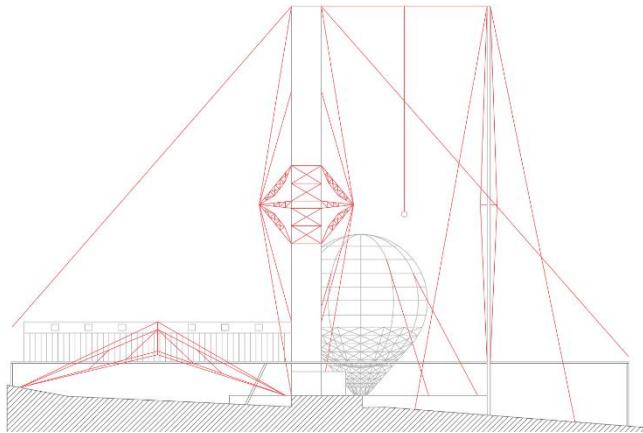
Alzado izquierdo según esta colocada la planta en la Fig.23. En este alzado se pueden apreciar los cables de acero que forman parte de la composición del alzado.
